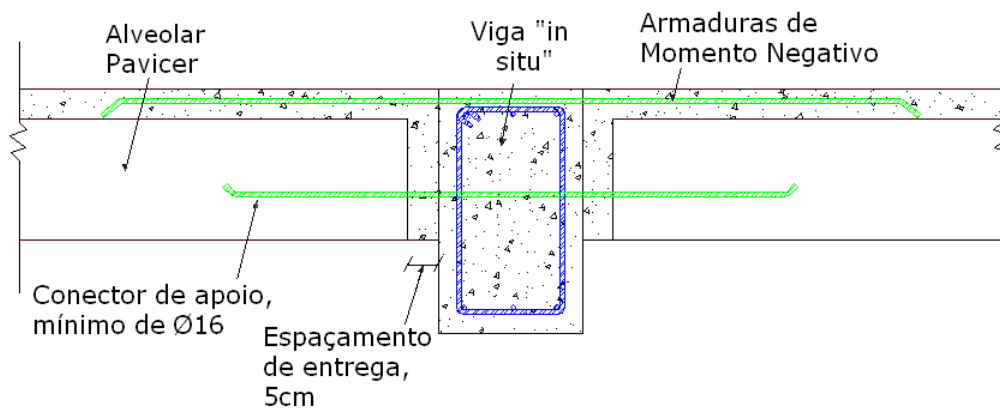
Pormenor tipo de apoio em viga central alta.
